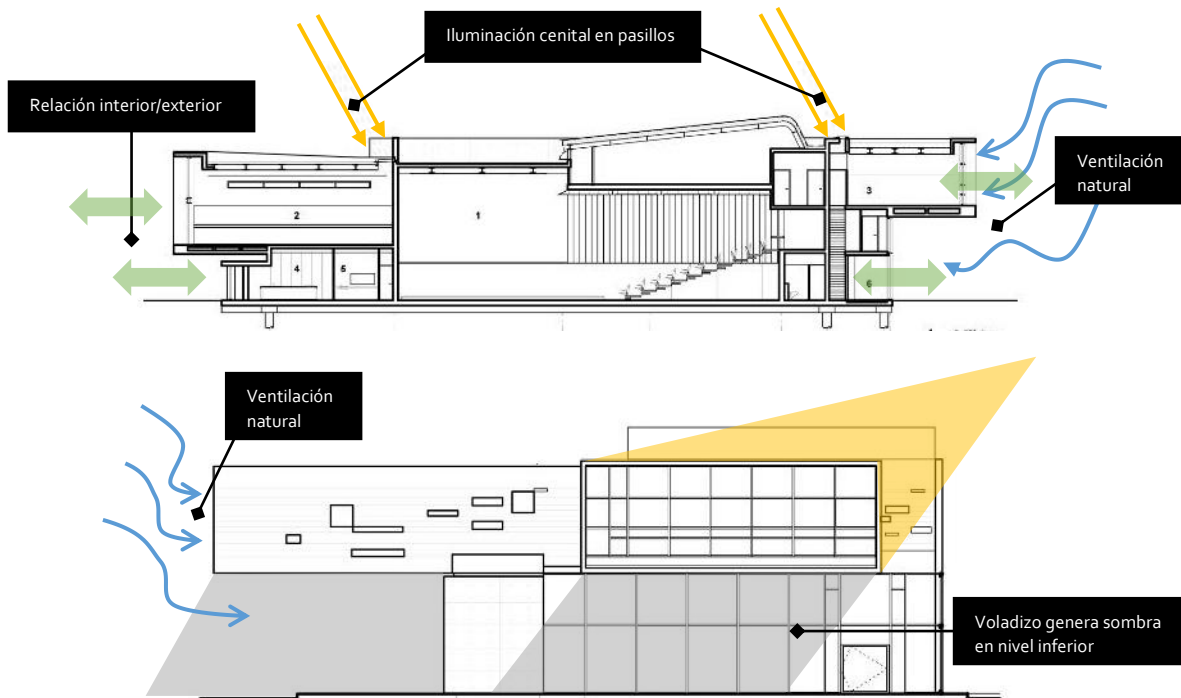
Sección longitudinal y fachada sur del Centro cultural de Sedan.
